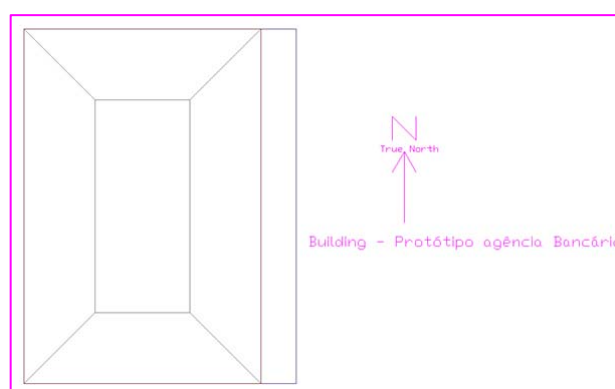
Planta baixa do protótipo apresentando as zonas térmicas no padrão *core and shell*.
